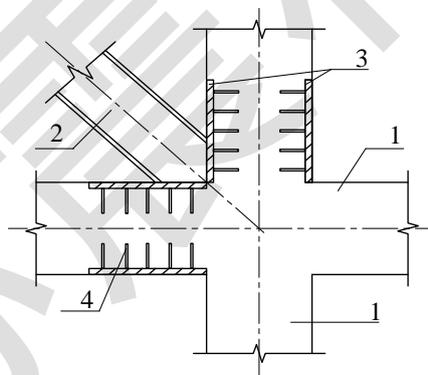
钢支撑与现浇混凝土框架节点域连接构造
